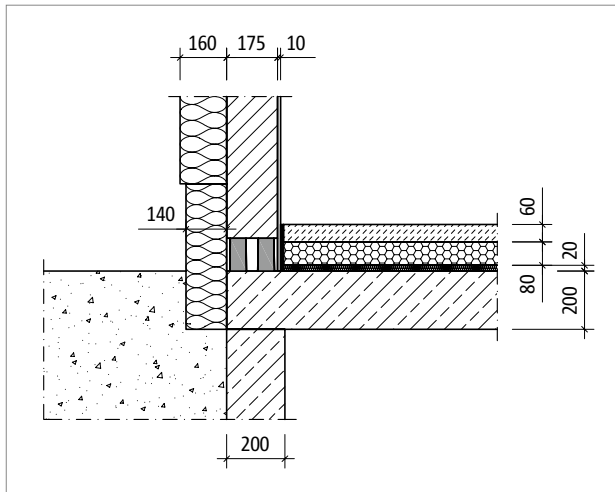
Effiziente Wärmedämmung mit Schöck Sconnex® Typ M
